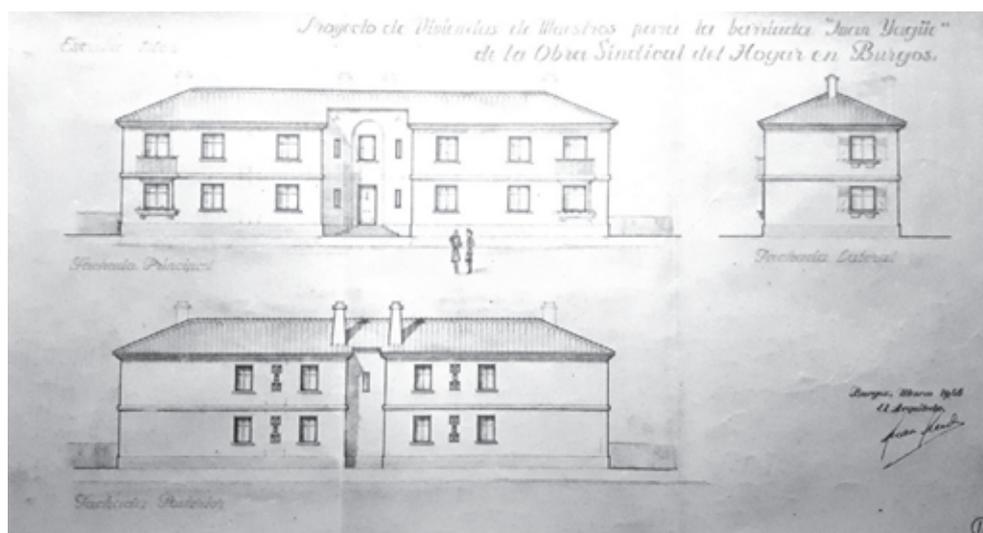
Plano de vistas de fachada de las viviendas de maestros, perteneciente al proyecto de grupo escolar y viviendas de maestros para la Obra Sindical del Hogar en Burgos, Grupo «Juan Yagüe» en la Barriada Juan Yagüe. Burgos, marzo de 1946. Fuente: ACFomJCyL, exp. 1660
